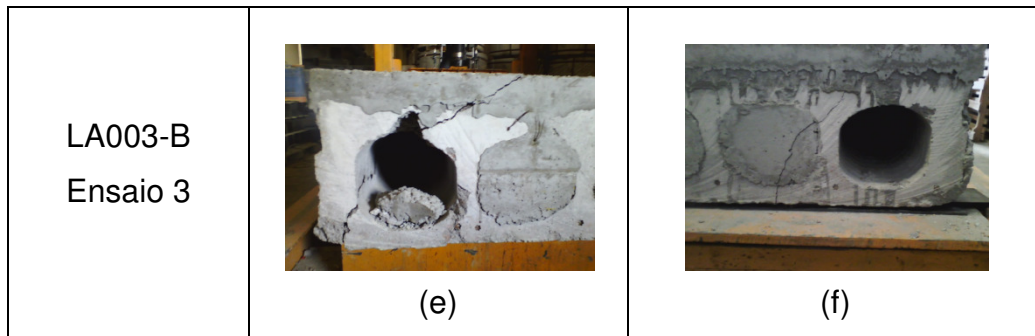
FISSURAS DAS LAJES LA003-B APÓS OS ENSAIOS.
